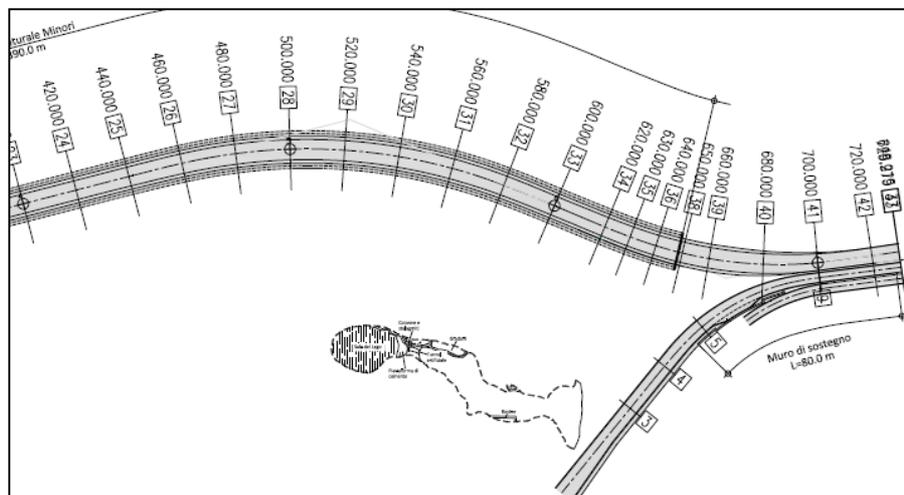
Planimetria Alternativa 1, con localizzazione della Grotta dell'Annunziata (n. 17).
